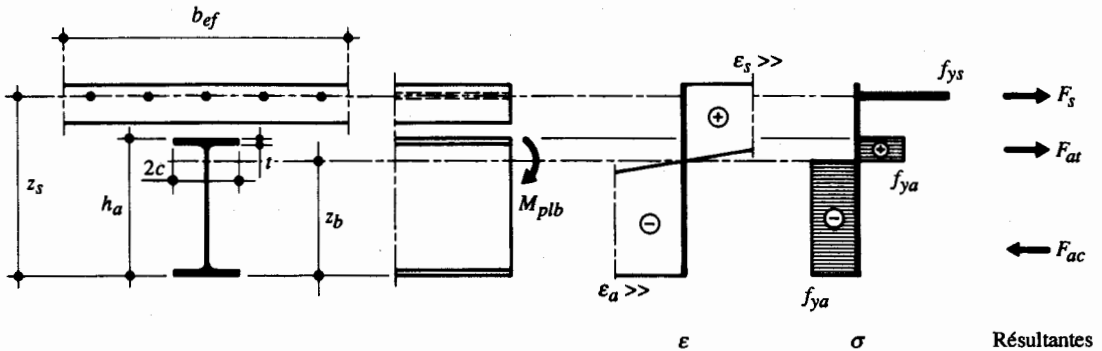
Section de poutre mixte sur appui (calcul plastique).
